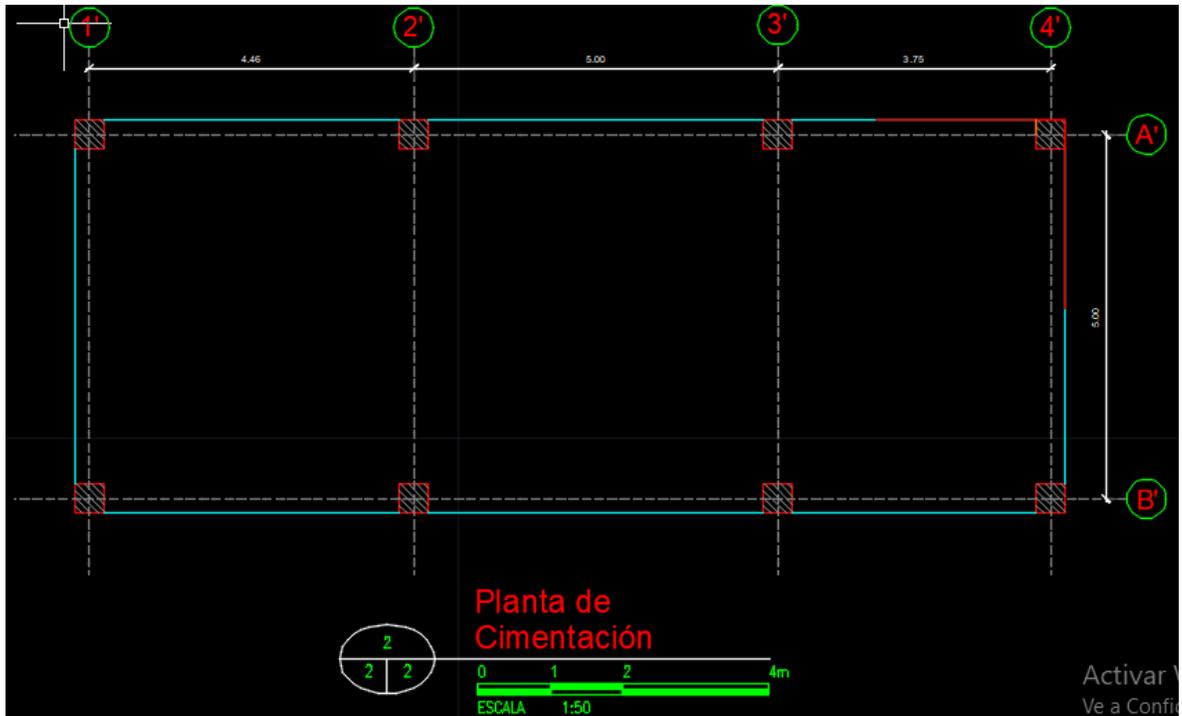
Planta de Cimentación portería Reserva del Rosario
